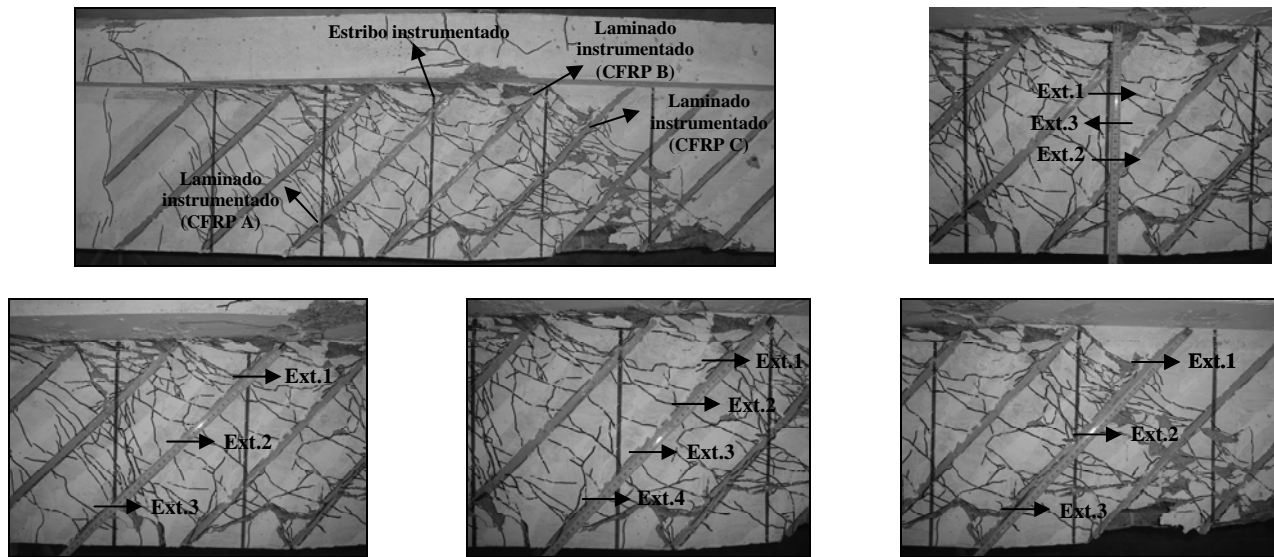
Localização dos extensómetros no laminado e estribo instrumentados da viga 5S-9LI45-D.
